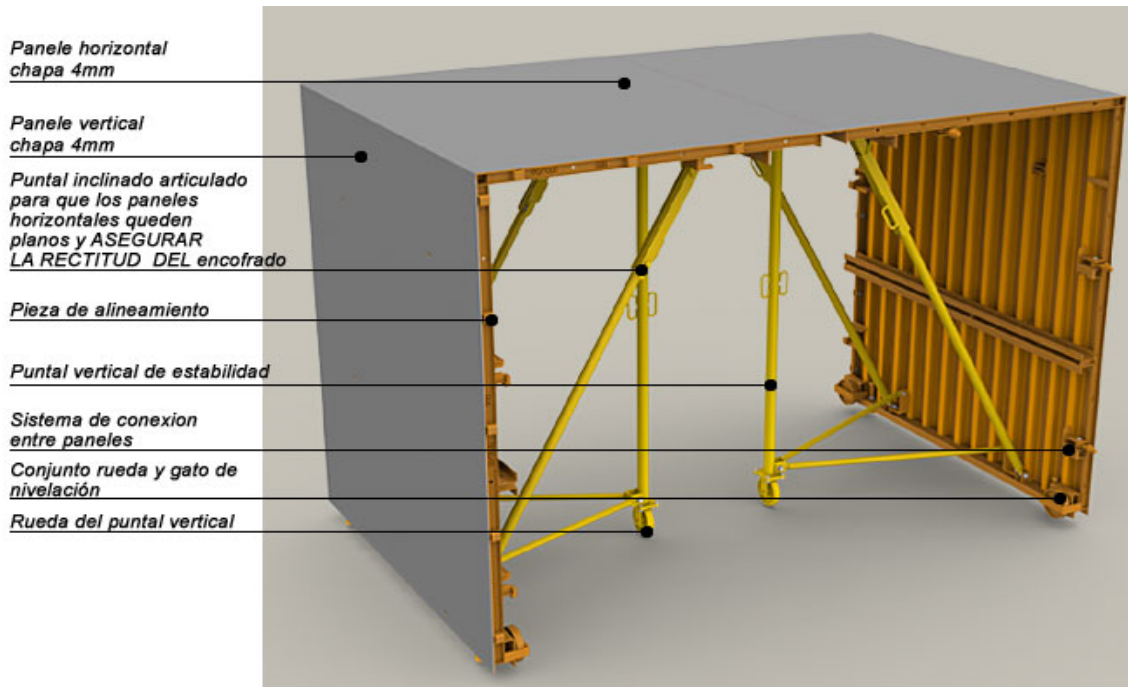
Ejemplo de encofrado tipo túnel fabricado por la empresa Outinord.
